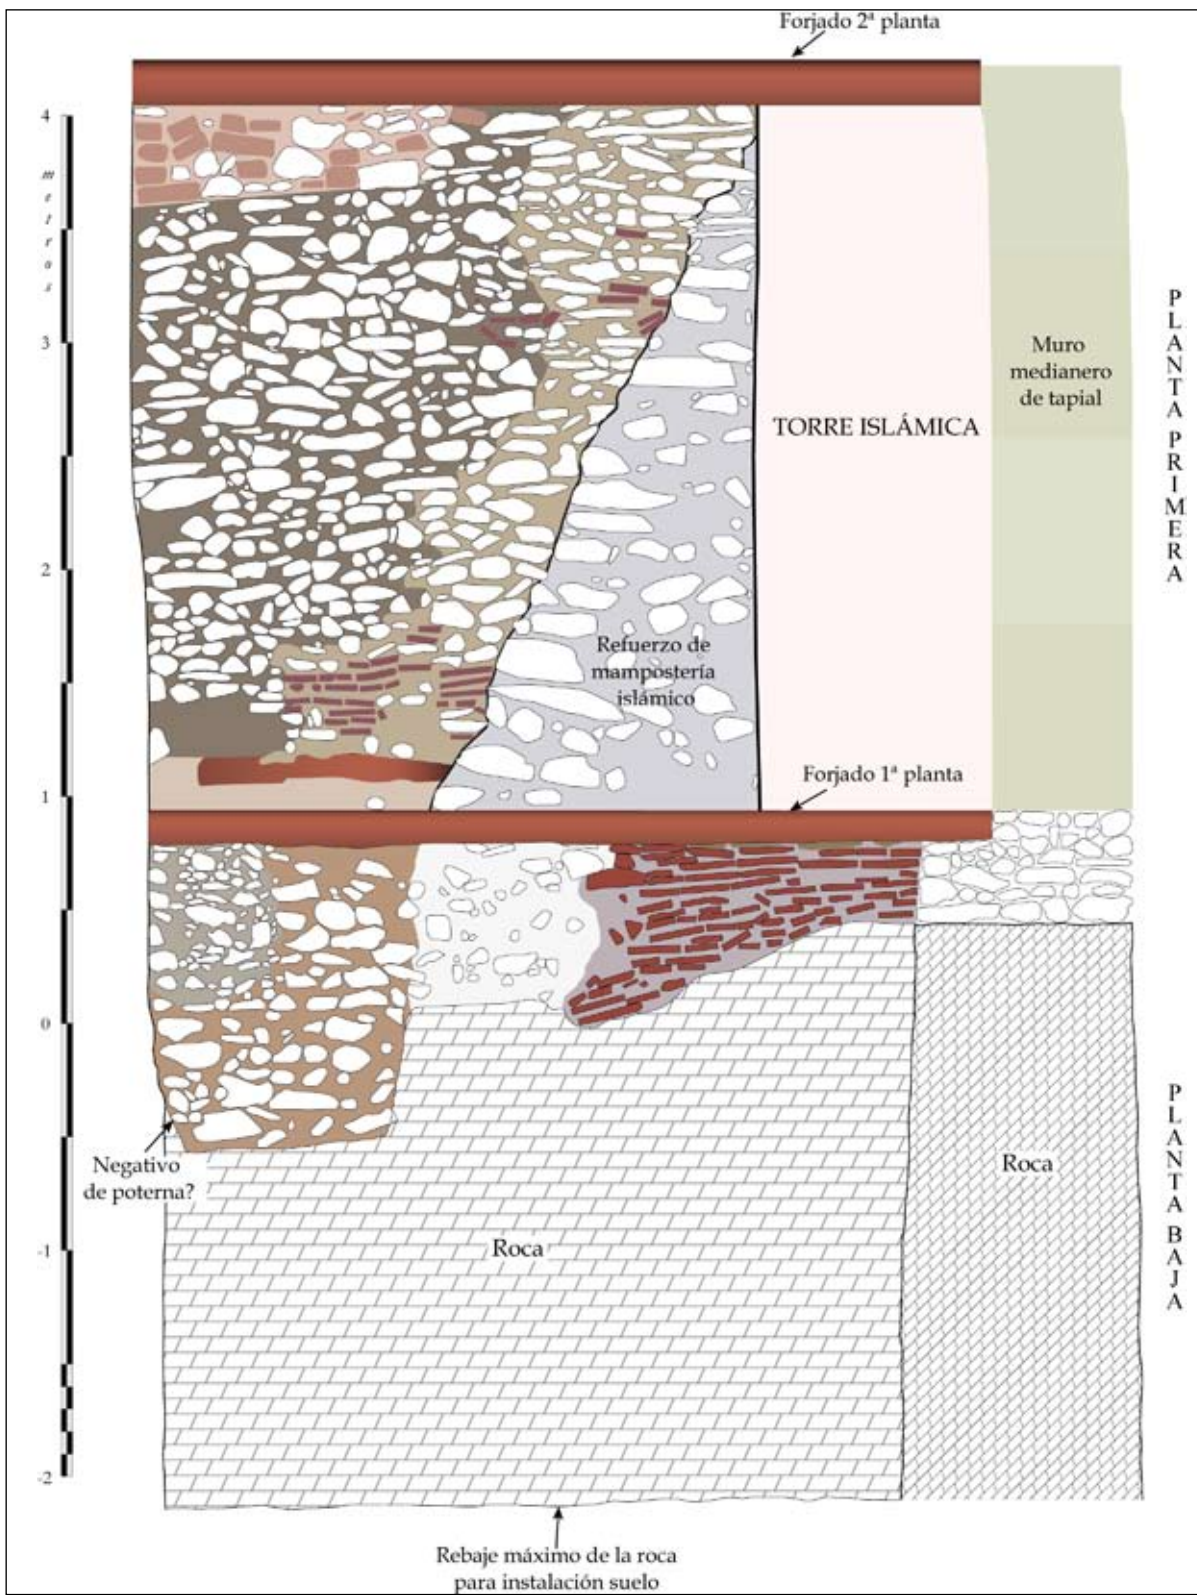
Alzado de la pared sur de la habitación H4 donde se ve como la planta inferior está excavada en la roca.
